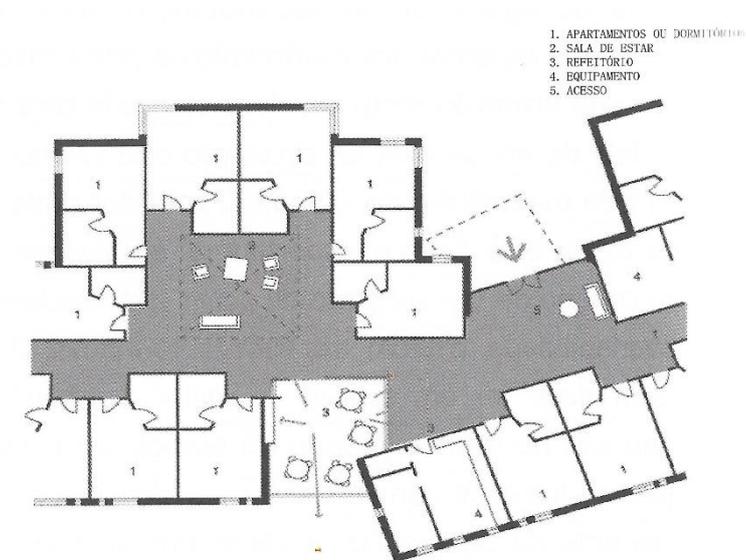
Exemplo de circulação com planta baixa dinâmica
